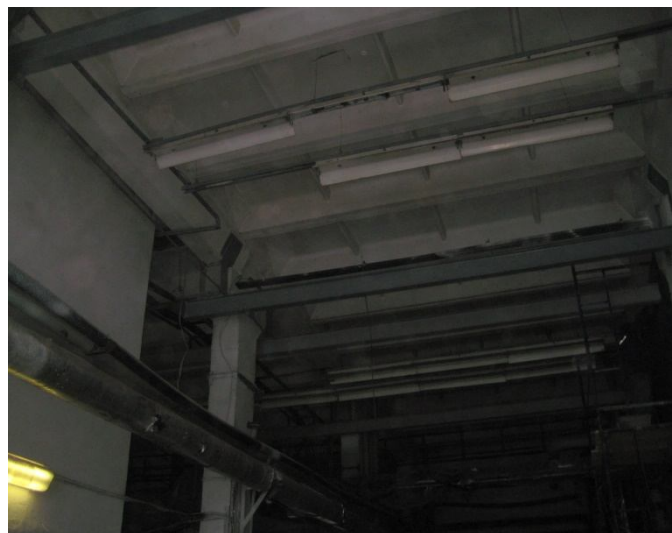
, 65. Общий вид ж/б конструкций перекрытия.
